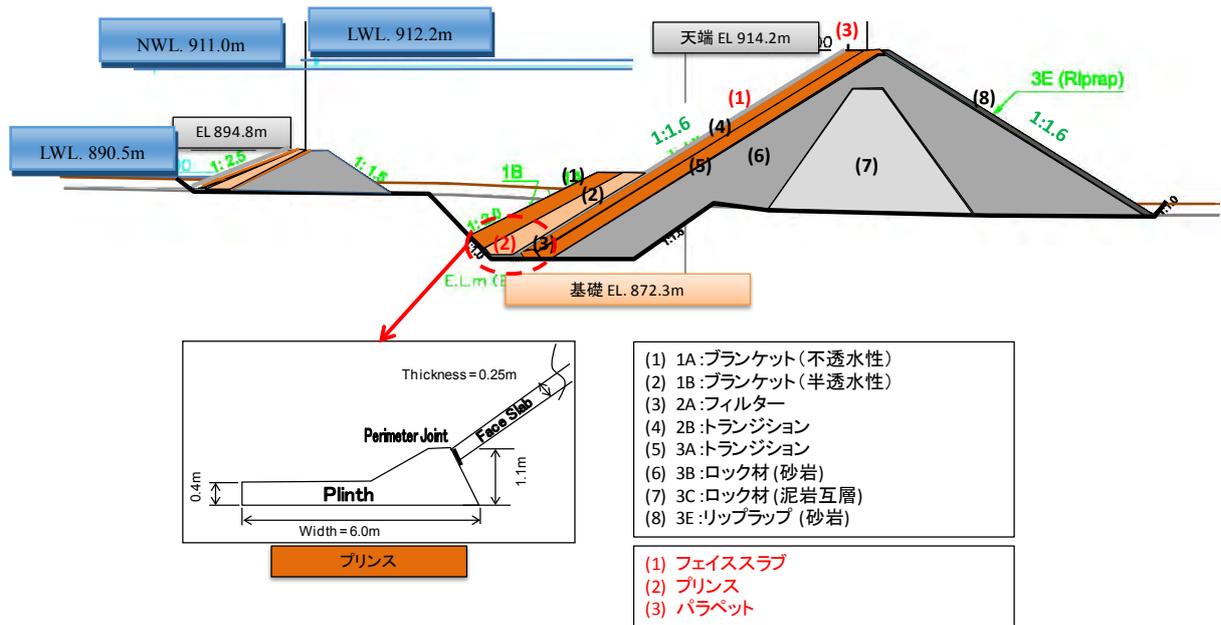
CFRD の標準断面 (H=41.9m, Section No1 +20.0m)
